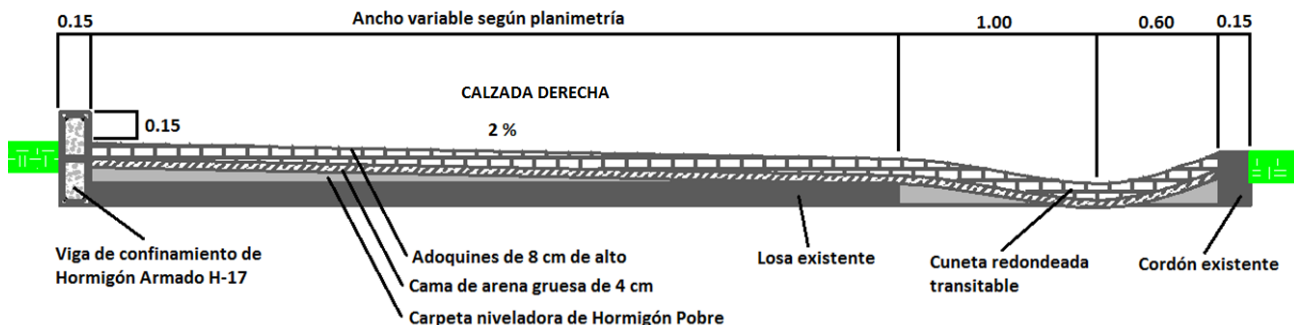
Detalle calzada derecha de Perfil Tipo T 1
